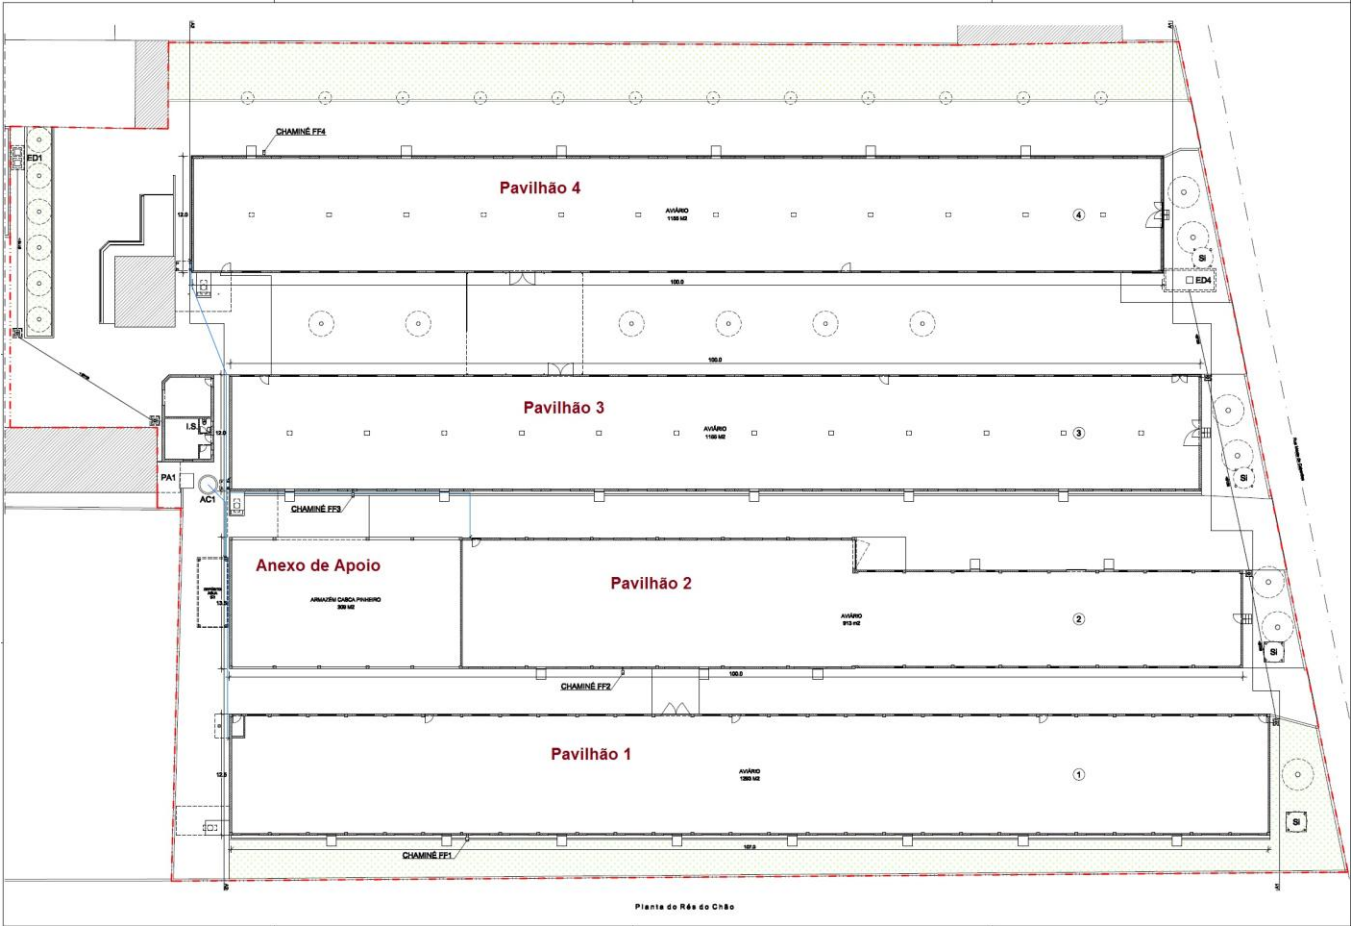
Planta esquemática do NP1: principais elementos edificados de produção e apoio (sem escala).
